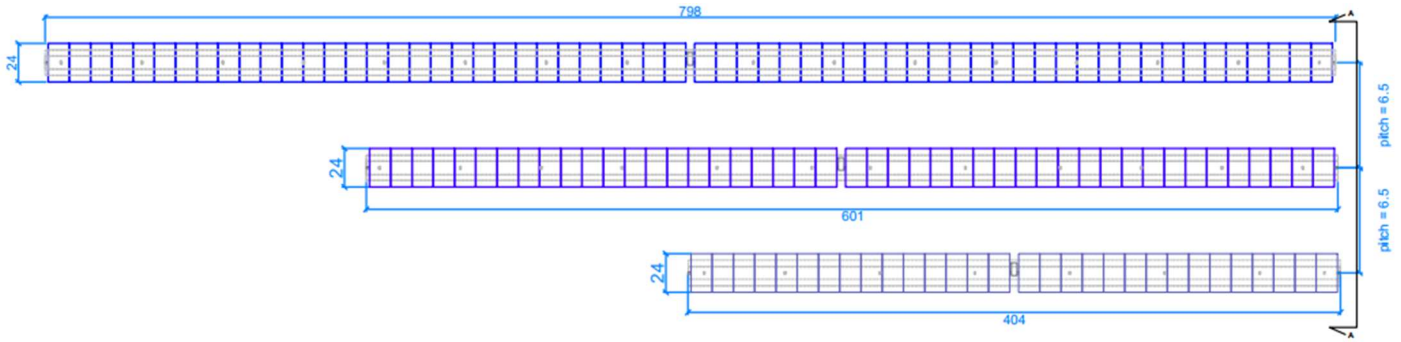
Vista in pianta dei tracker fotovoltaici previsti a progetto
